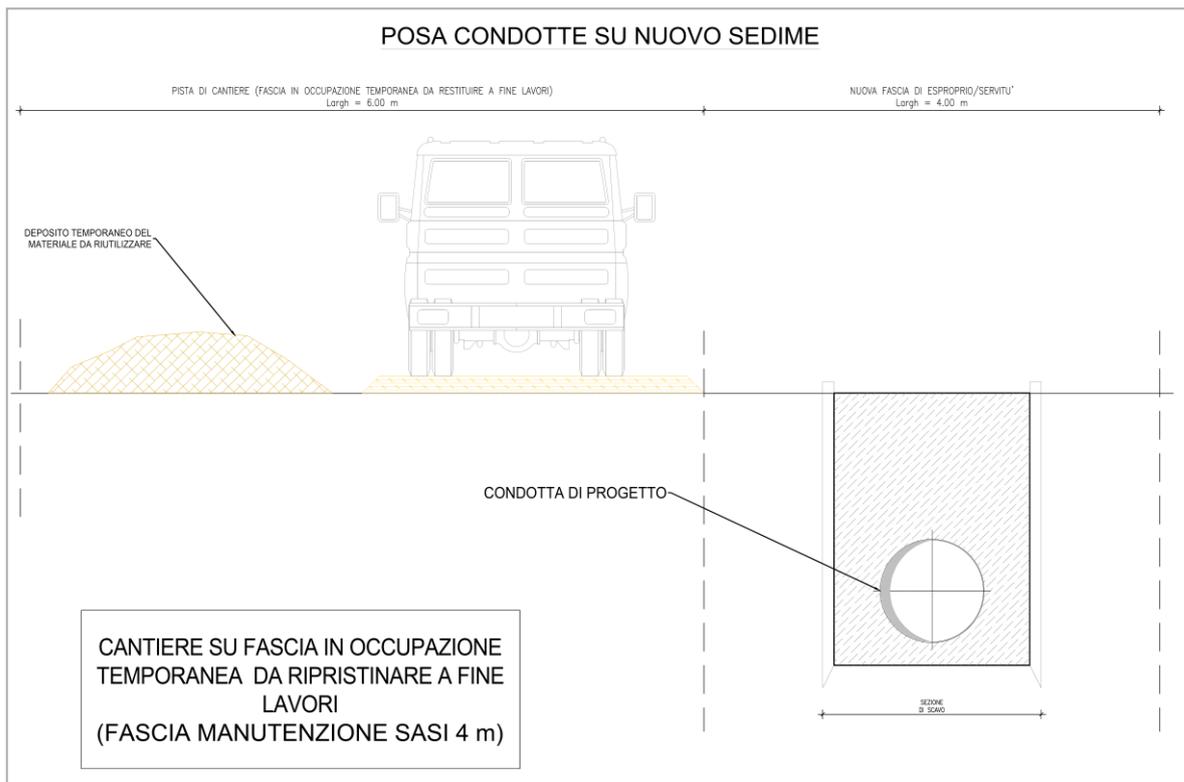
Sezione tipo di posa: condotta su nuovo sedime.
